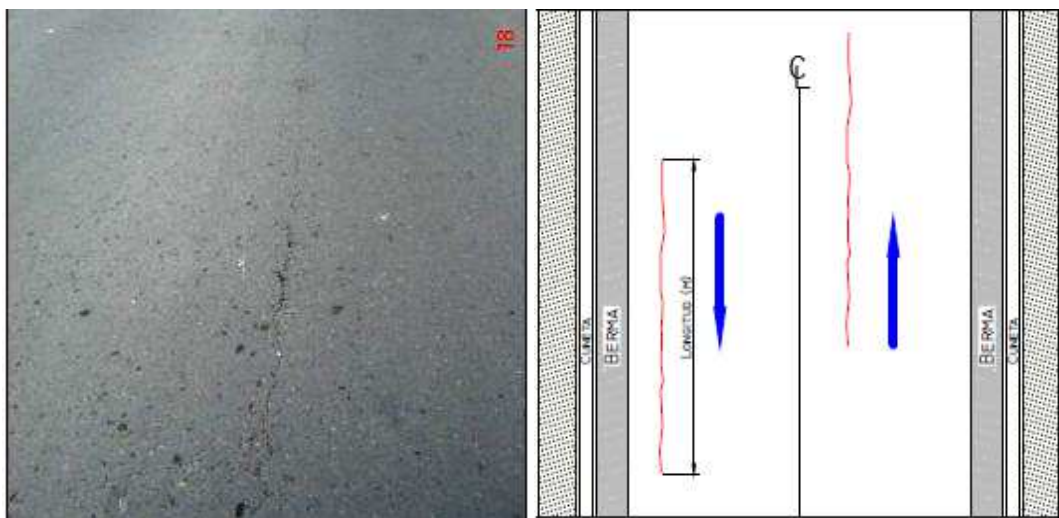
Fisuras FL, FT
